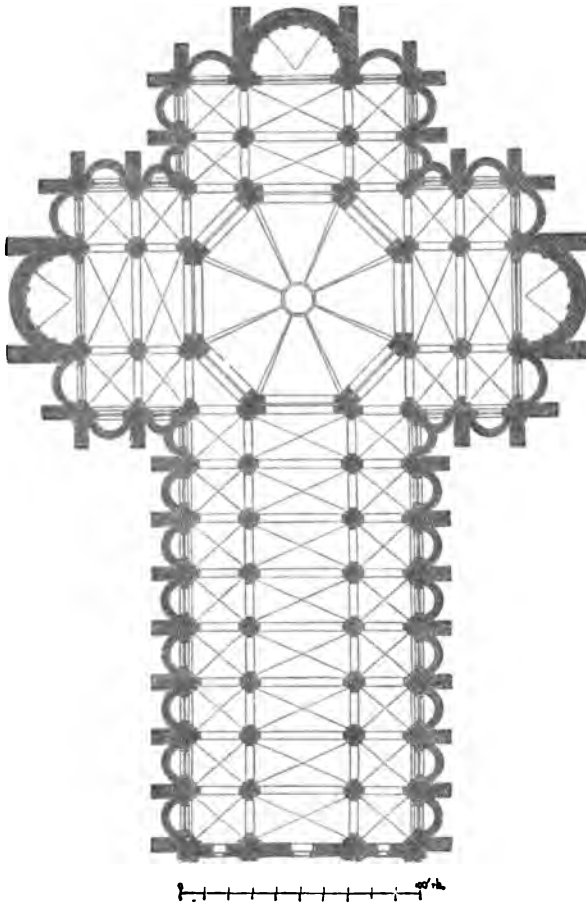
Dom zu Pavia. Grundriß. (W. L.)
